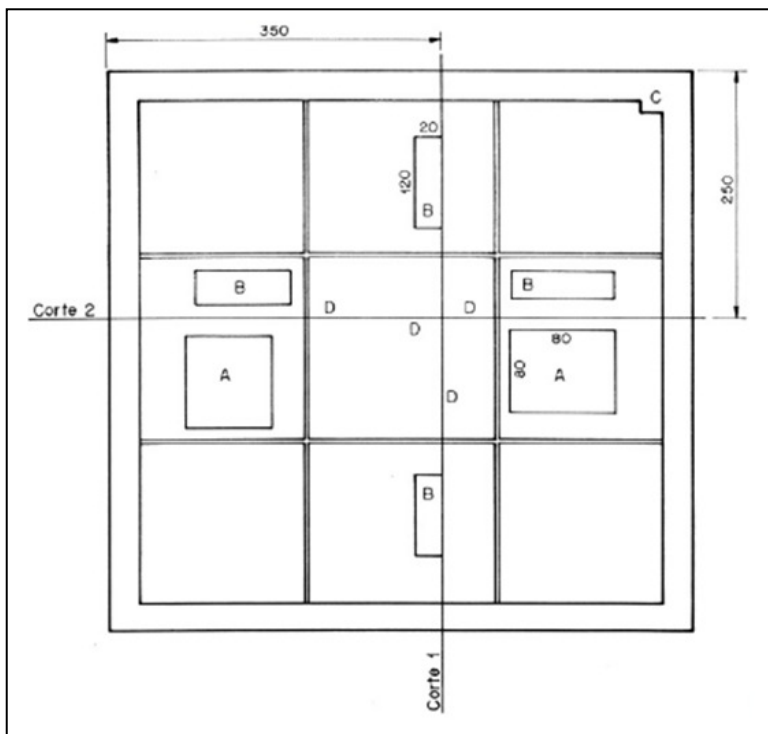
Croqui para ensaio de placas lisas de forro – NBR 12.775
